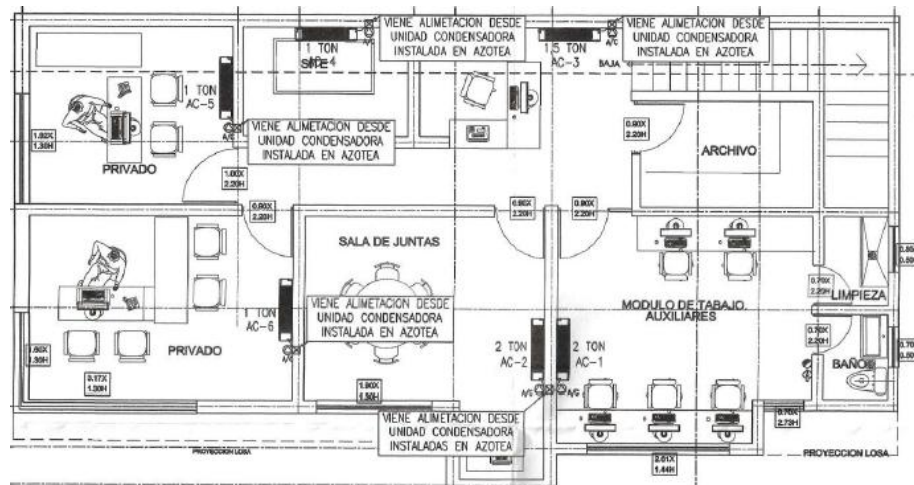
PLANO DE DISTRIBUCION PLANTA ALTA
